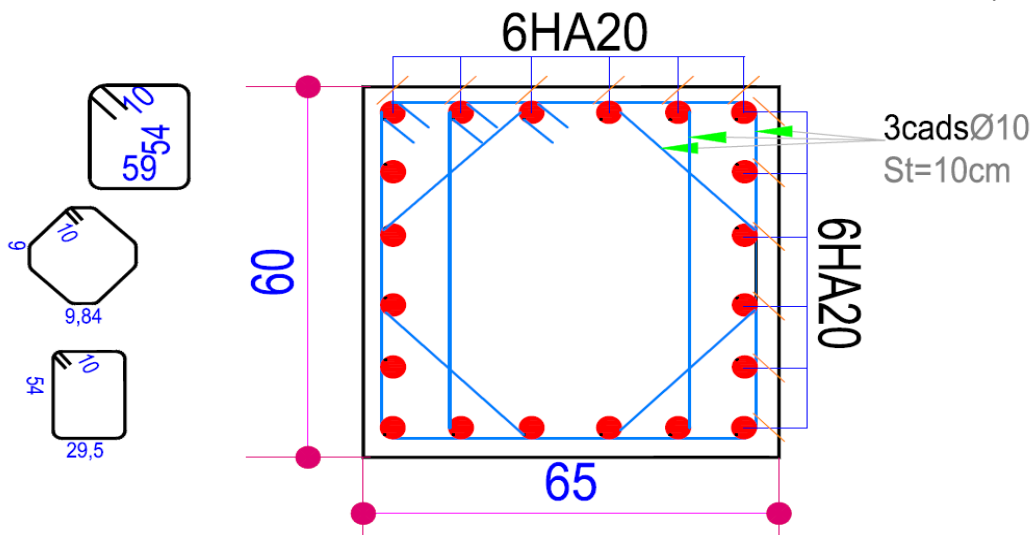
Schéma de ferrailage (Section transversale) des poteaux du RDC
